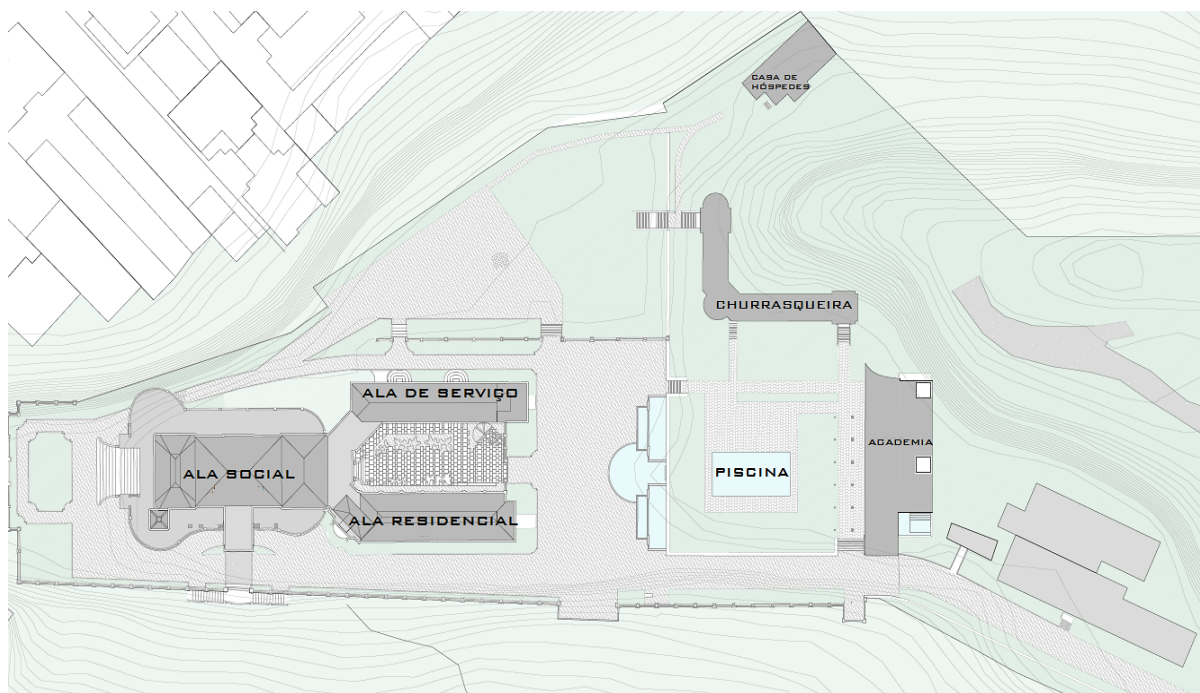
Plantas de Situação do Palácio Laranjeiras
